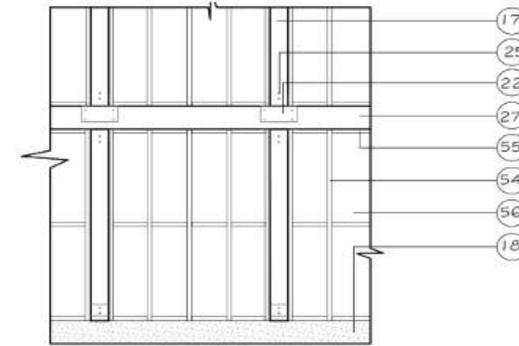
Detalle 12 (Mampostería del invernadero) (Tipología 3)-Esc:1/50
